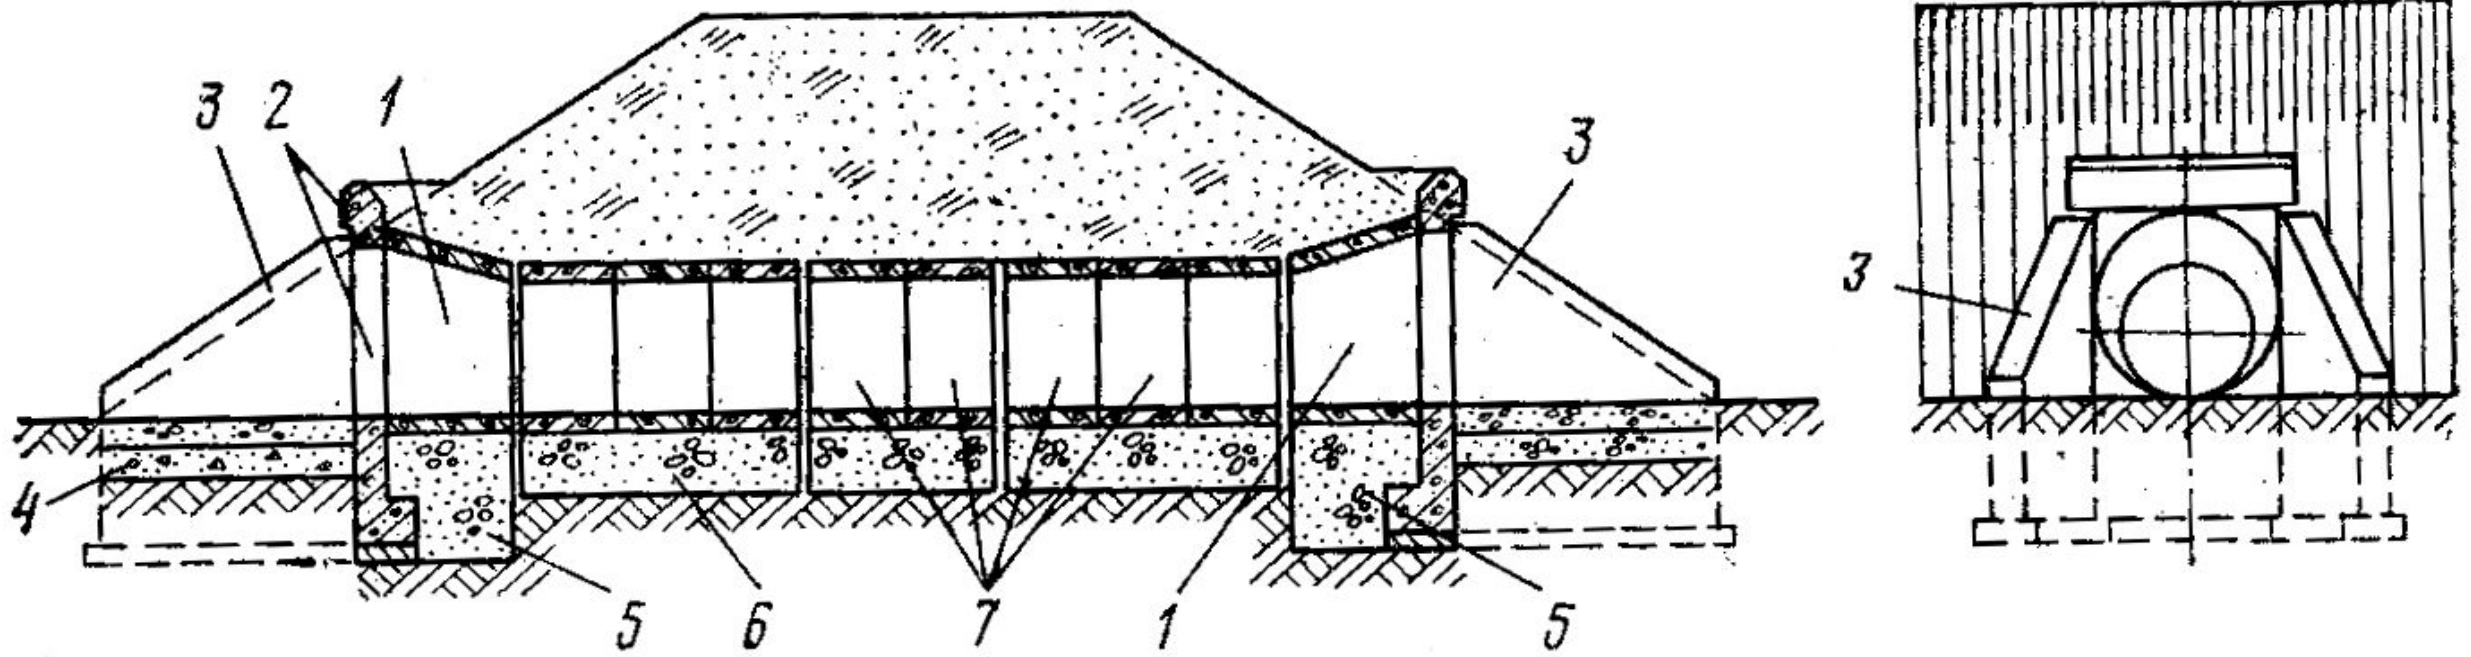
Конструктивная схема круглой трубы: 1 – звено оголовка; 2 – порталная стенка; 3 – откосная стенка; 4 – подготовка под бетонный лоток; 5 – фундамент звена оголовка; 6 – фундамент секции трубы; 7 – звенья тела трубы
